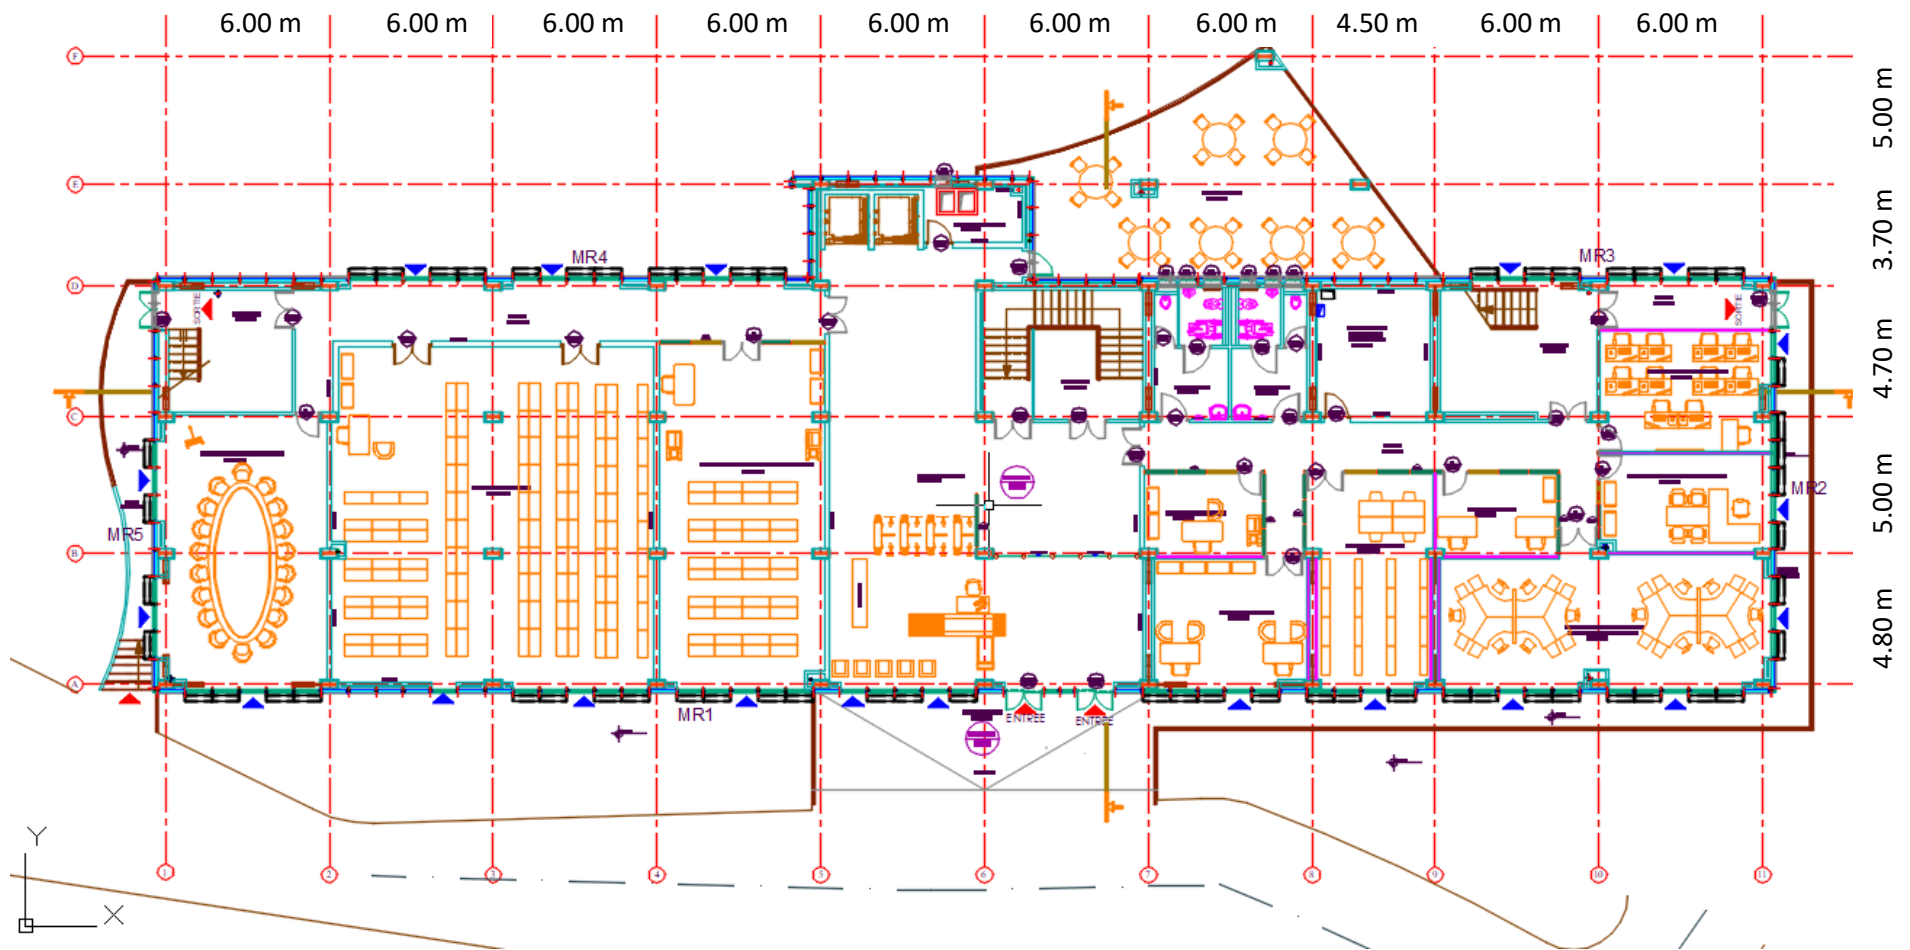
Plan d'architecture du rez-de-chaussée (Autodesk Autocad)
